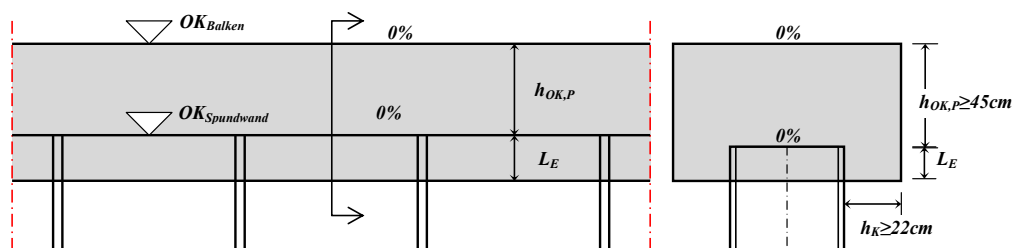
Schematische Darstellung des Stahlbetonholms für beide Ausführungsvarianten ohne Neigung (0 %)
